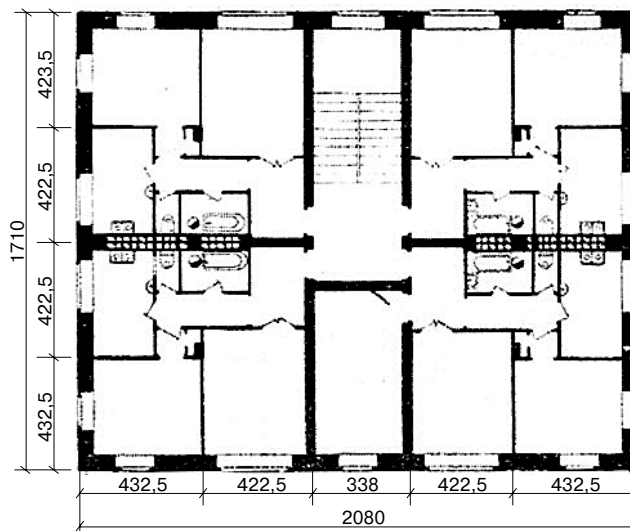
Планировка квартир двенадцатиквартирного жилого дома
